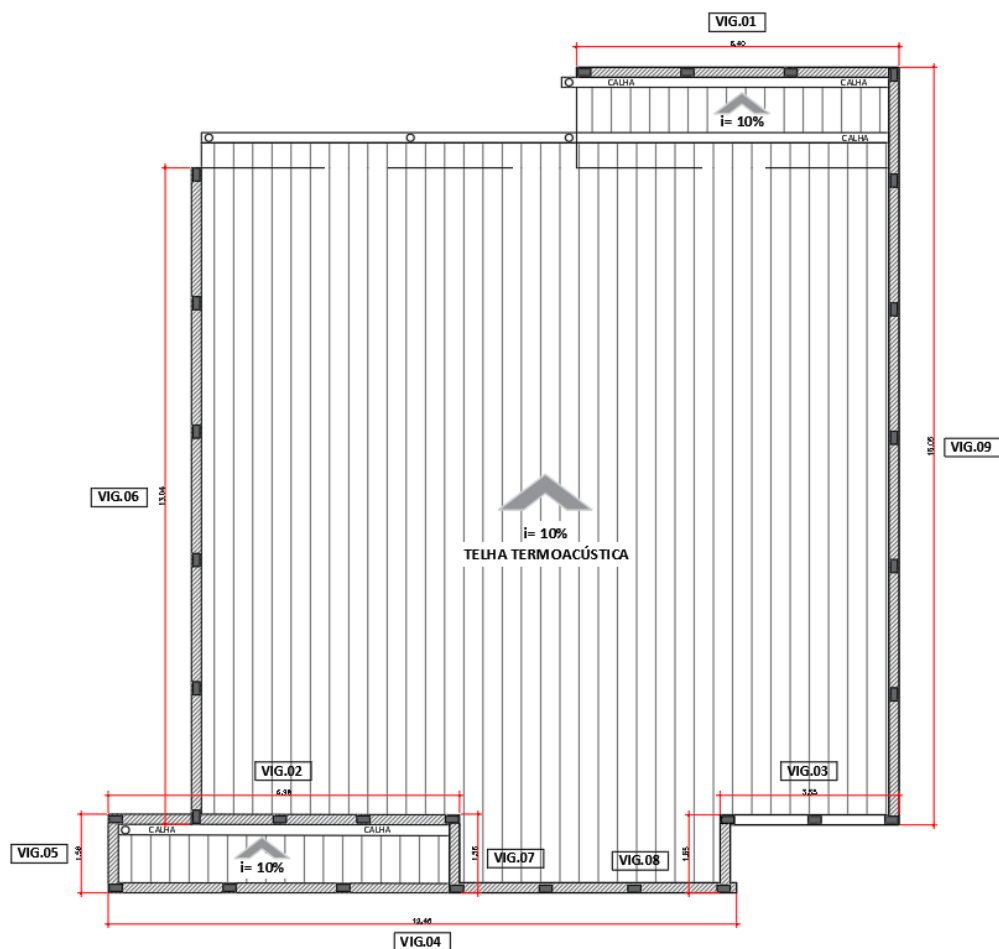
Planta de localização viga superior de respaldo platibanda.
